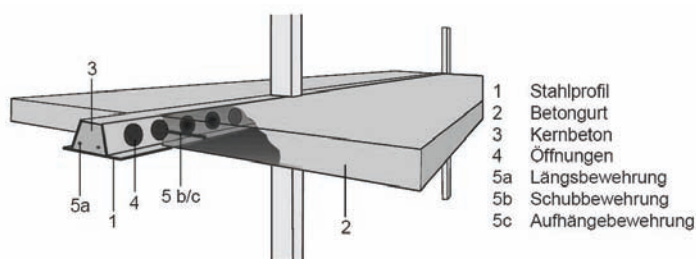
Slim-Floor Profil mit ausbetonierten, hohlkastenförmigen Stahlprofil [Schäfer 2007]
